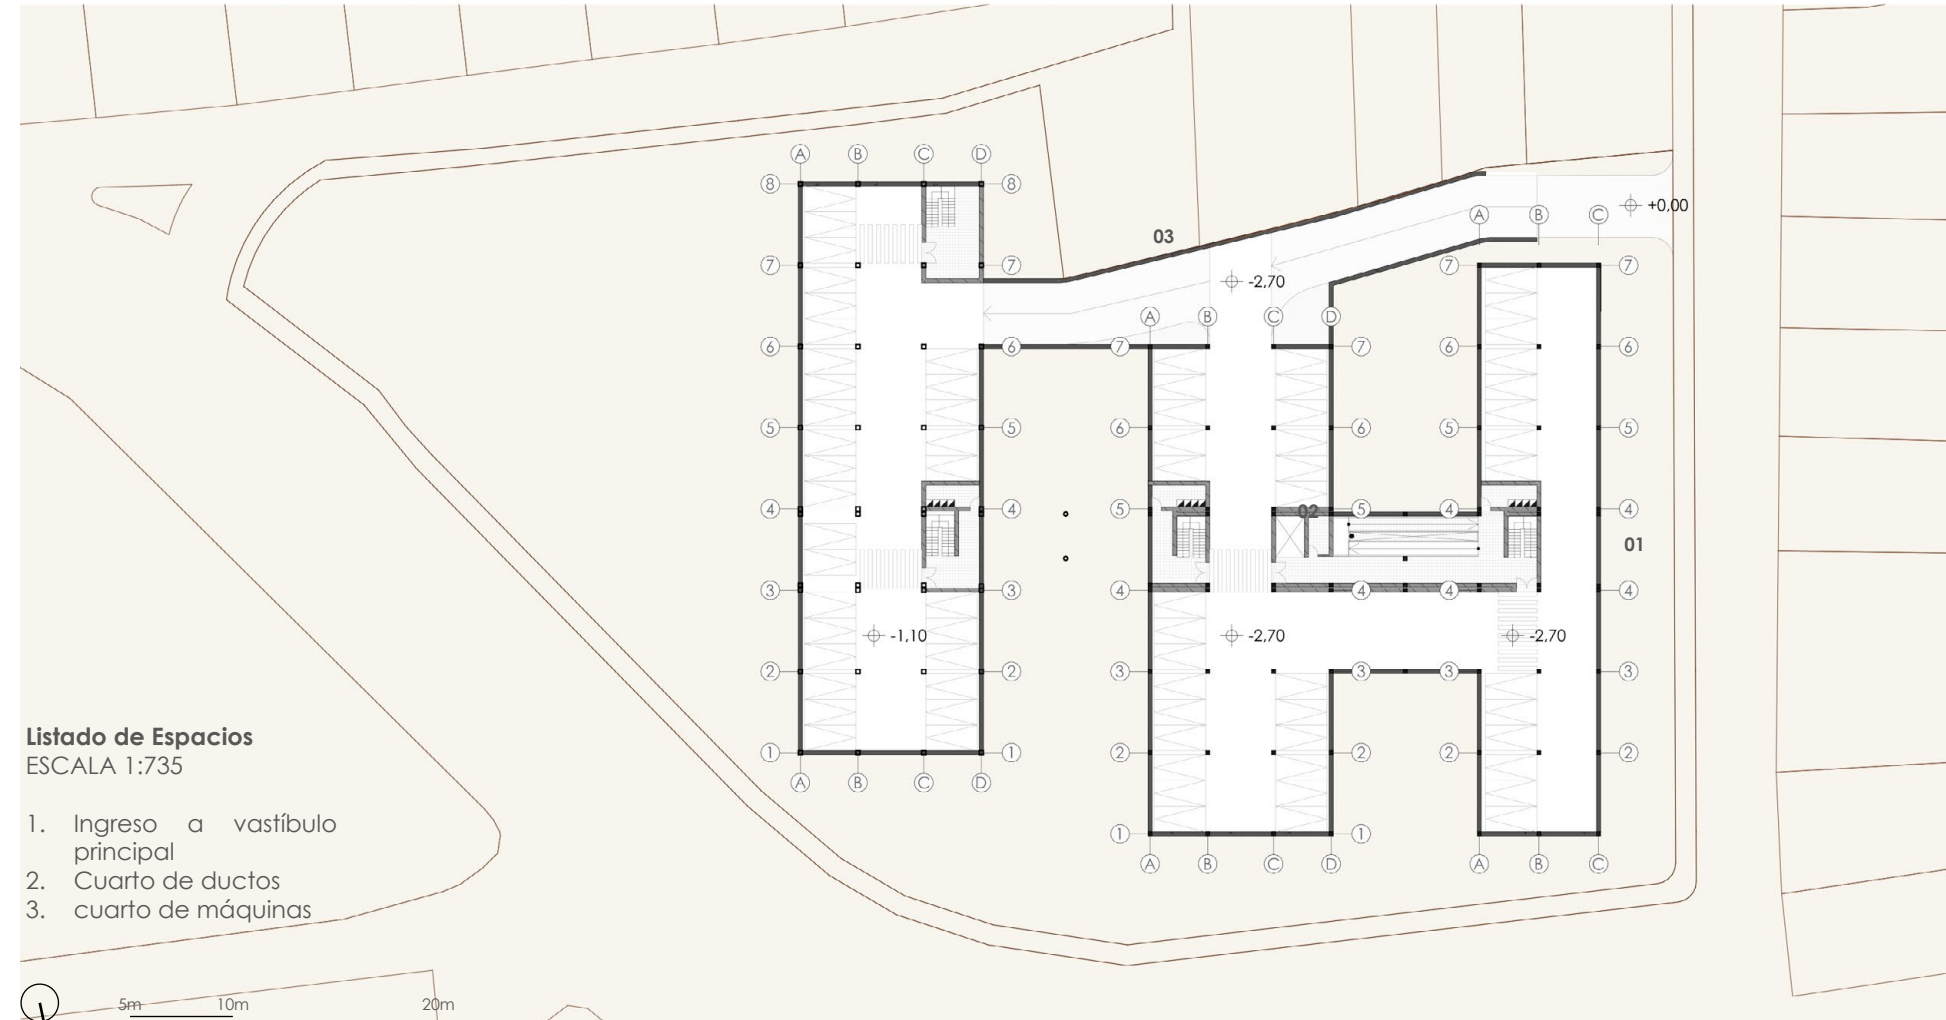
Planta Subsuelo. Fuente: Autoría propia.
